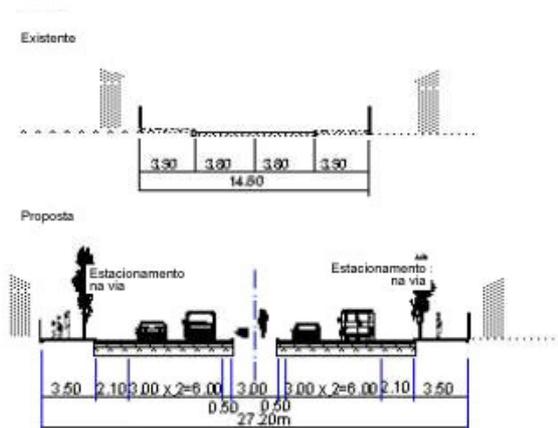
Seção Transversal proposta para Rua Yamada
